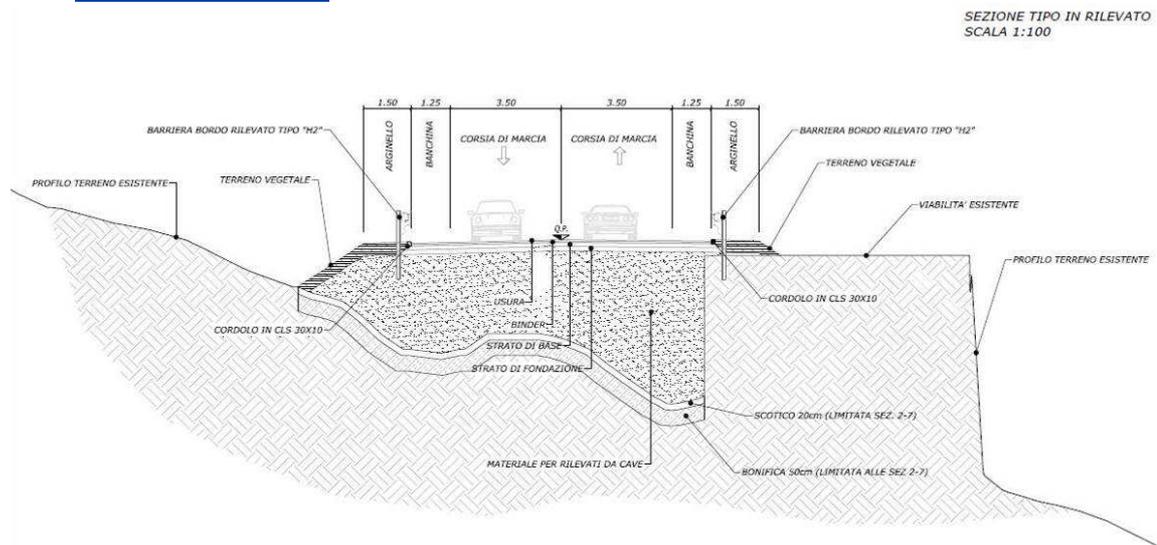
Sezione stradale di tipo C2 prevista per l'intervento in oggetto
